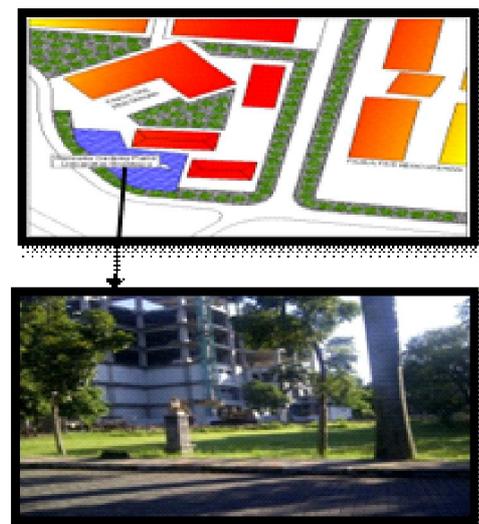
RencanaLahan Area Gedung Parkir Baru
